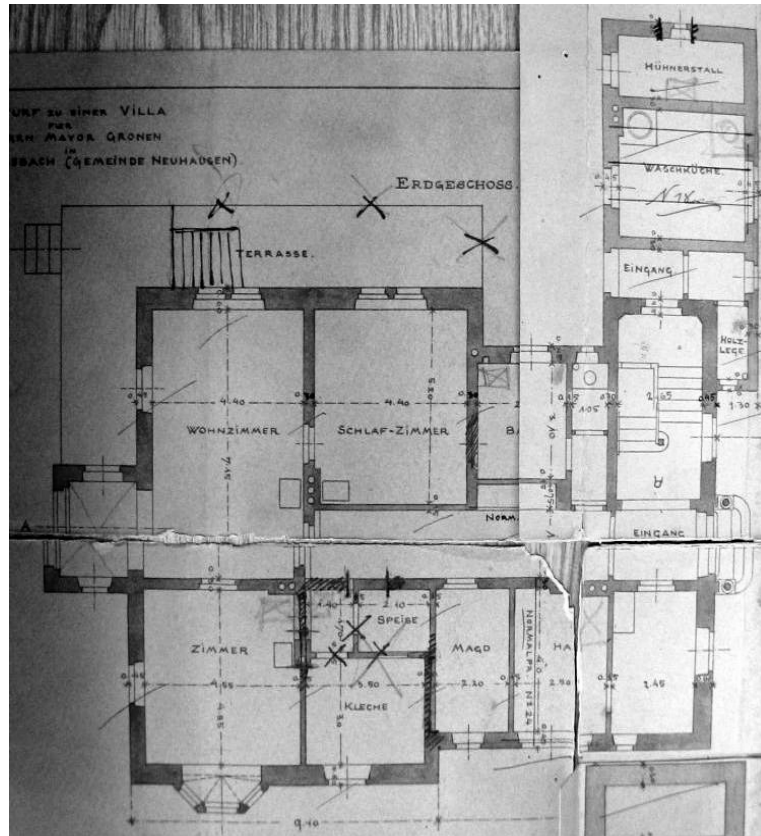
Villa Gronen, Grundriß Erdgeschoß, Leonhard Romeis, 1889, Plan nach Süden ausgerichtet.
